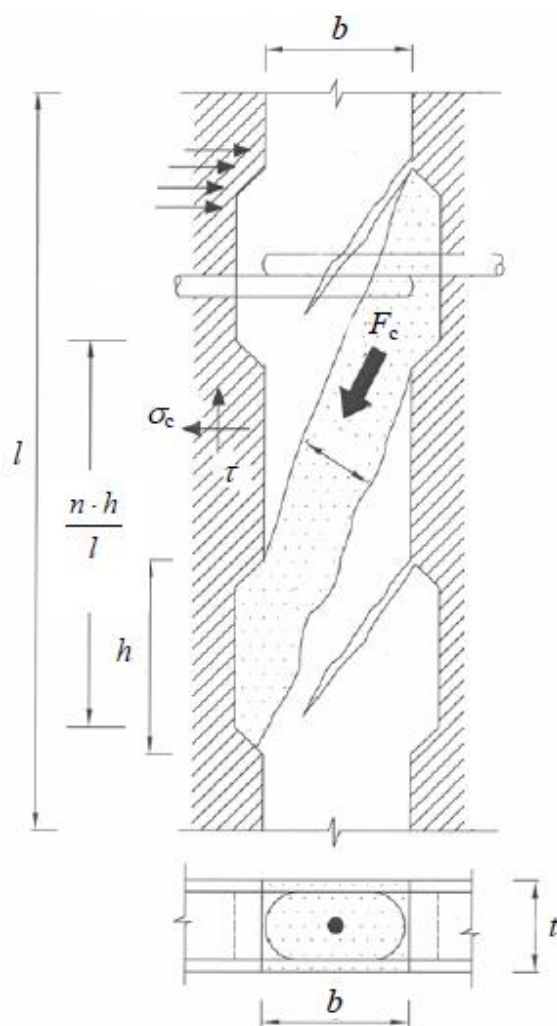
Mecanismos de transferência de cisalhamento em juntas de painéis de concreto armado.
